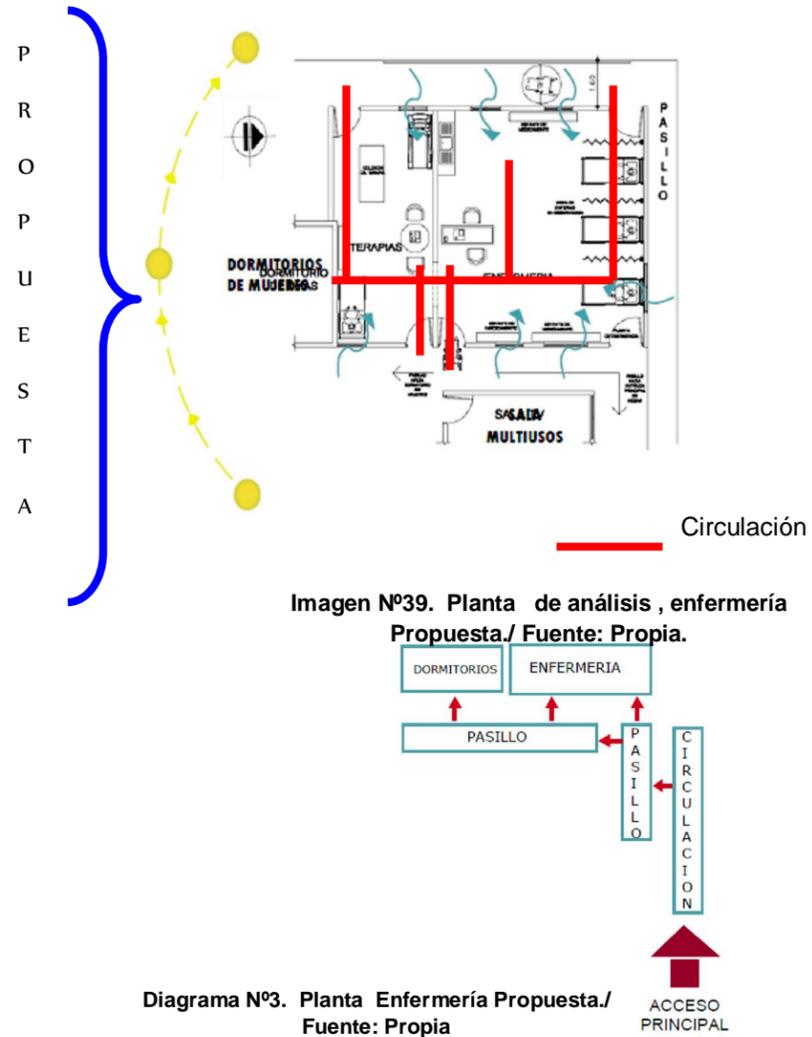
Planta de análisis, enfermería Propuesta./ Fuente: Propia.
